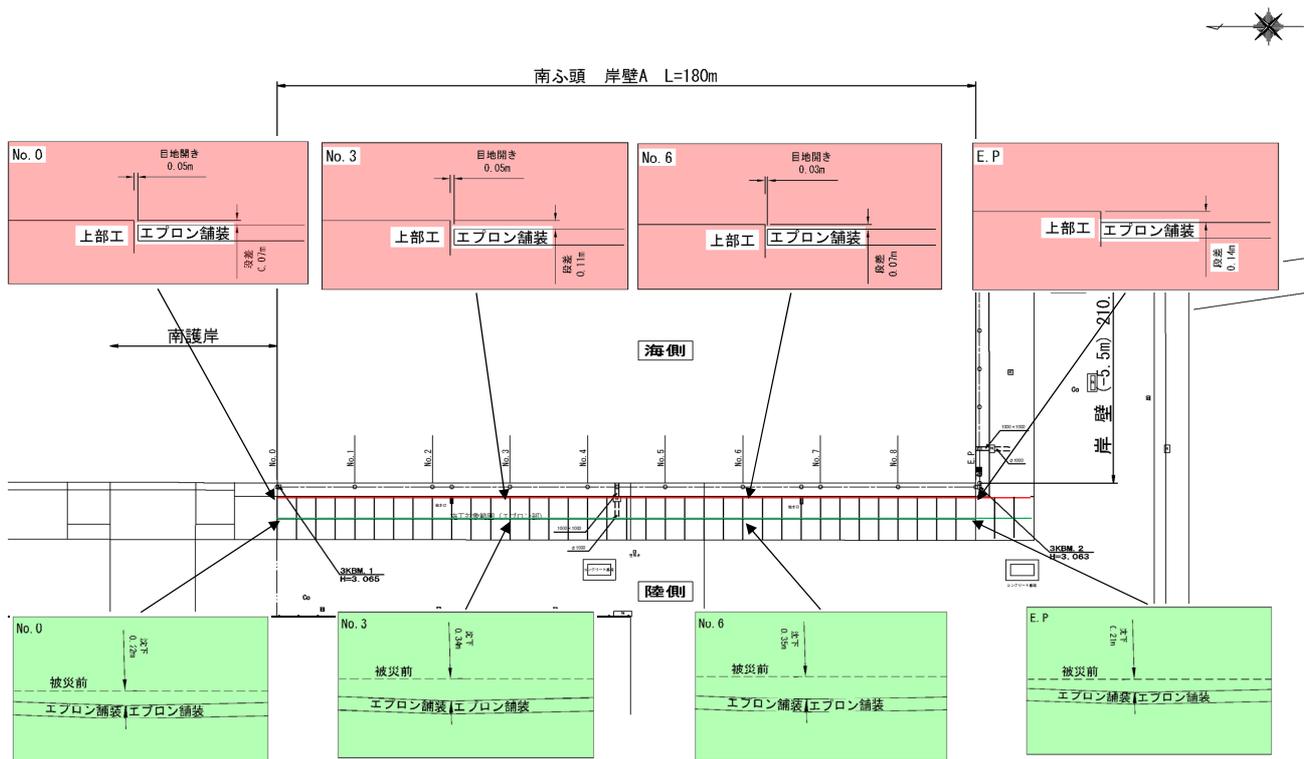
240 No.21 常陸那珂港区_南ふ頭地区 A 岸壁 (-5.5m) の平面図 (被災後)
